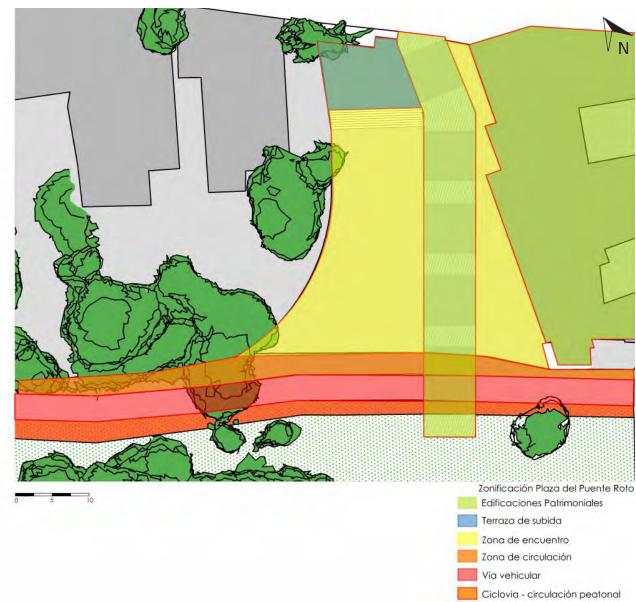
Zonificación de la plaza del Puente Roto (estado actual) FUENTE: Elaboración propia.
